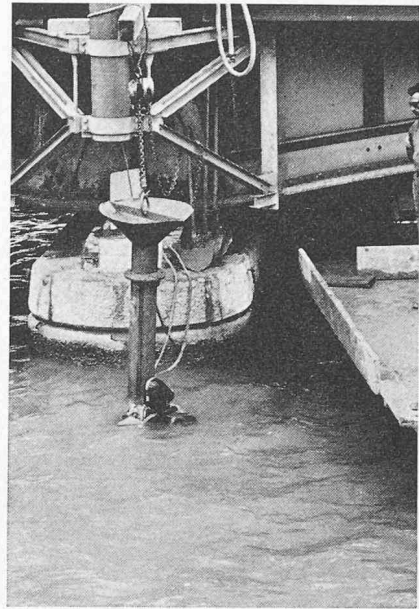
Bétonnage d'une semelle. Mise en place de la goulotte.
